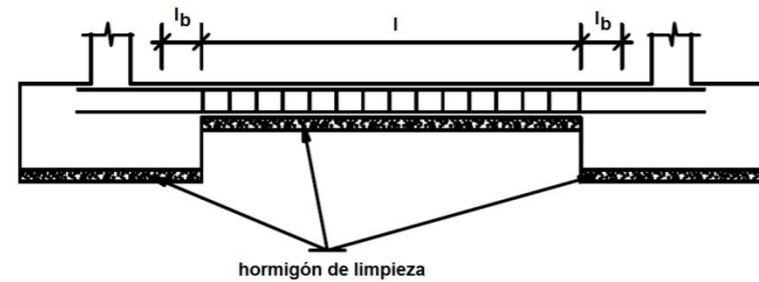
Esquema de cimentación con viga de atado. Fuente: El blog de Víctor Yepes.
